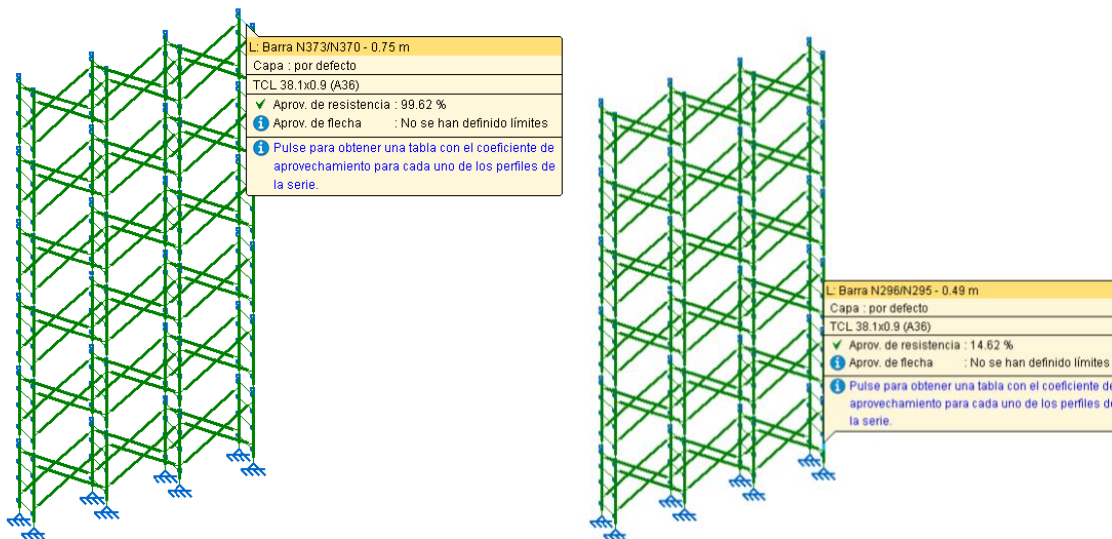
IMAGEN CON ESFUERZOS DE TRABAJO EN BARRAS DE LA ESTRUCTURA.
